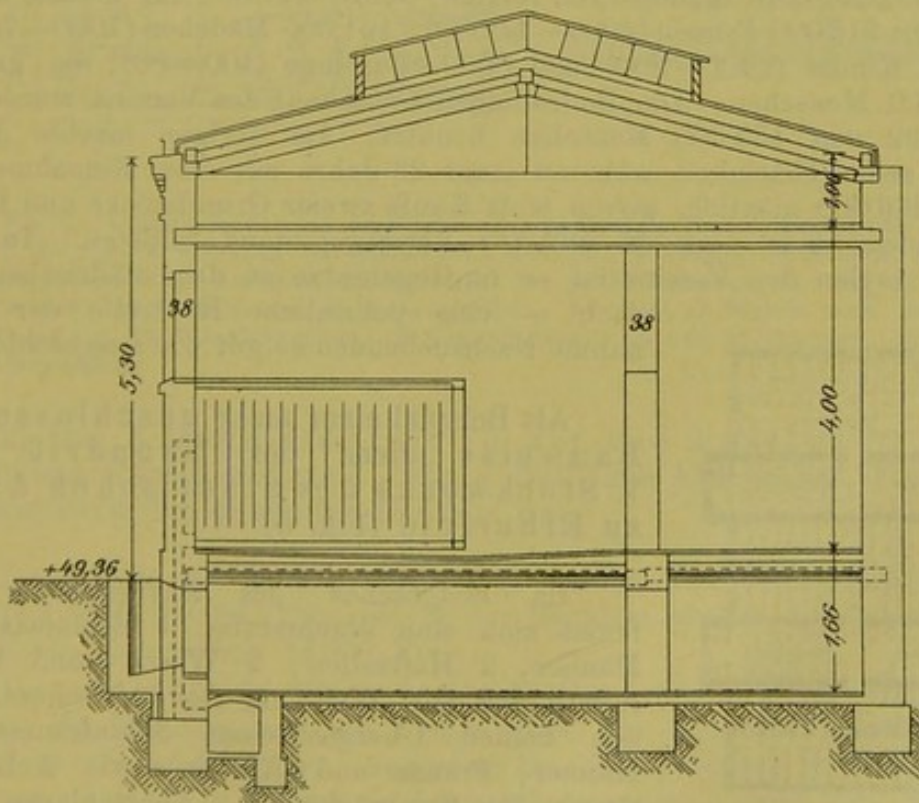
Städtisches Obdach für nächtliche Obdachlose zu Berlin. Längsschnitt durch das Brausebad.
